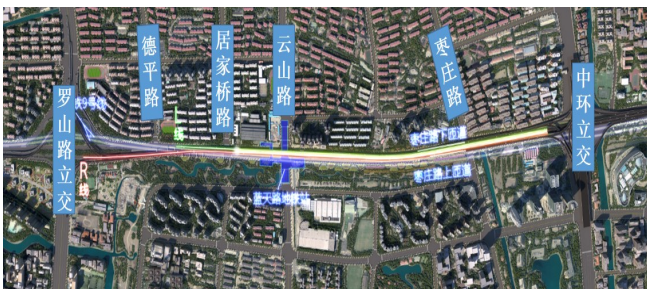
杨高中路（罗山路立交~中环立交）改建工程总平面图
